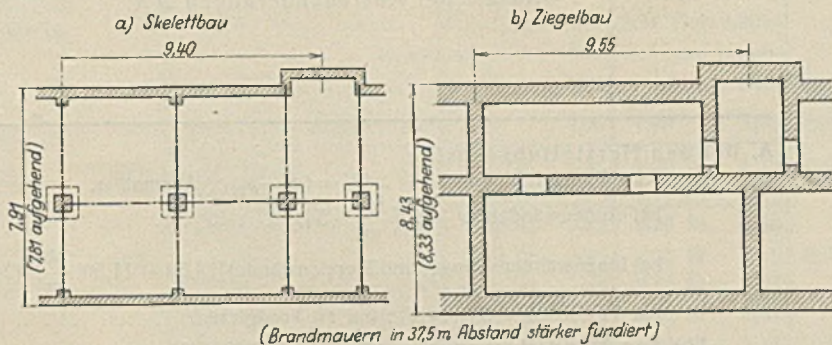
u. b. Unterschiede beim Kellergrundriß.
